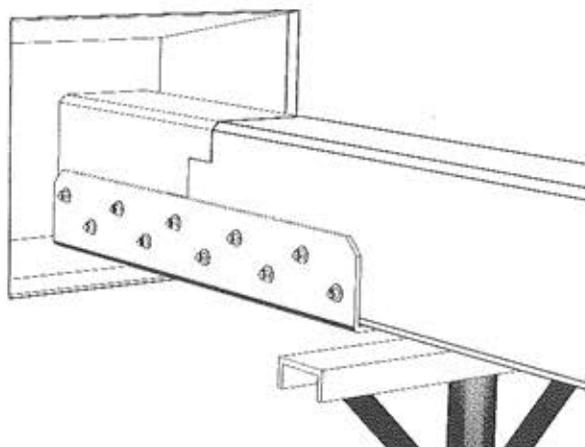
a - Ricostruzione dell'appoggio della trave con protesi d'acciaio all'intradosso e rigenerazione con legno della parte di trave rimossa.
